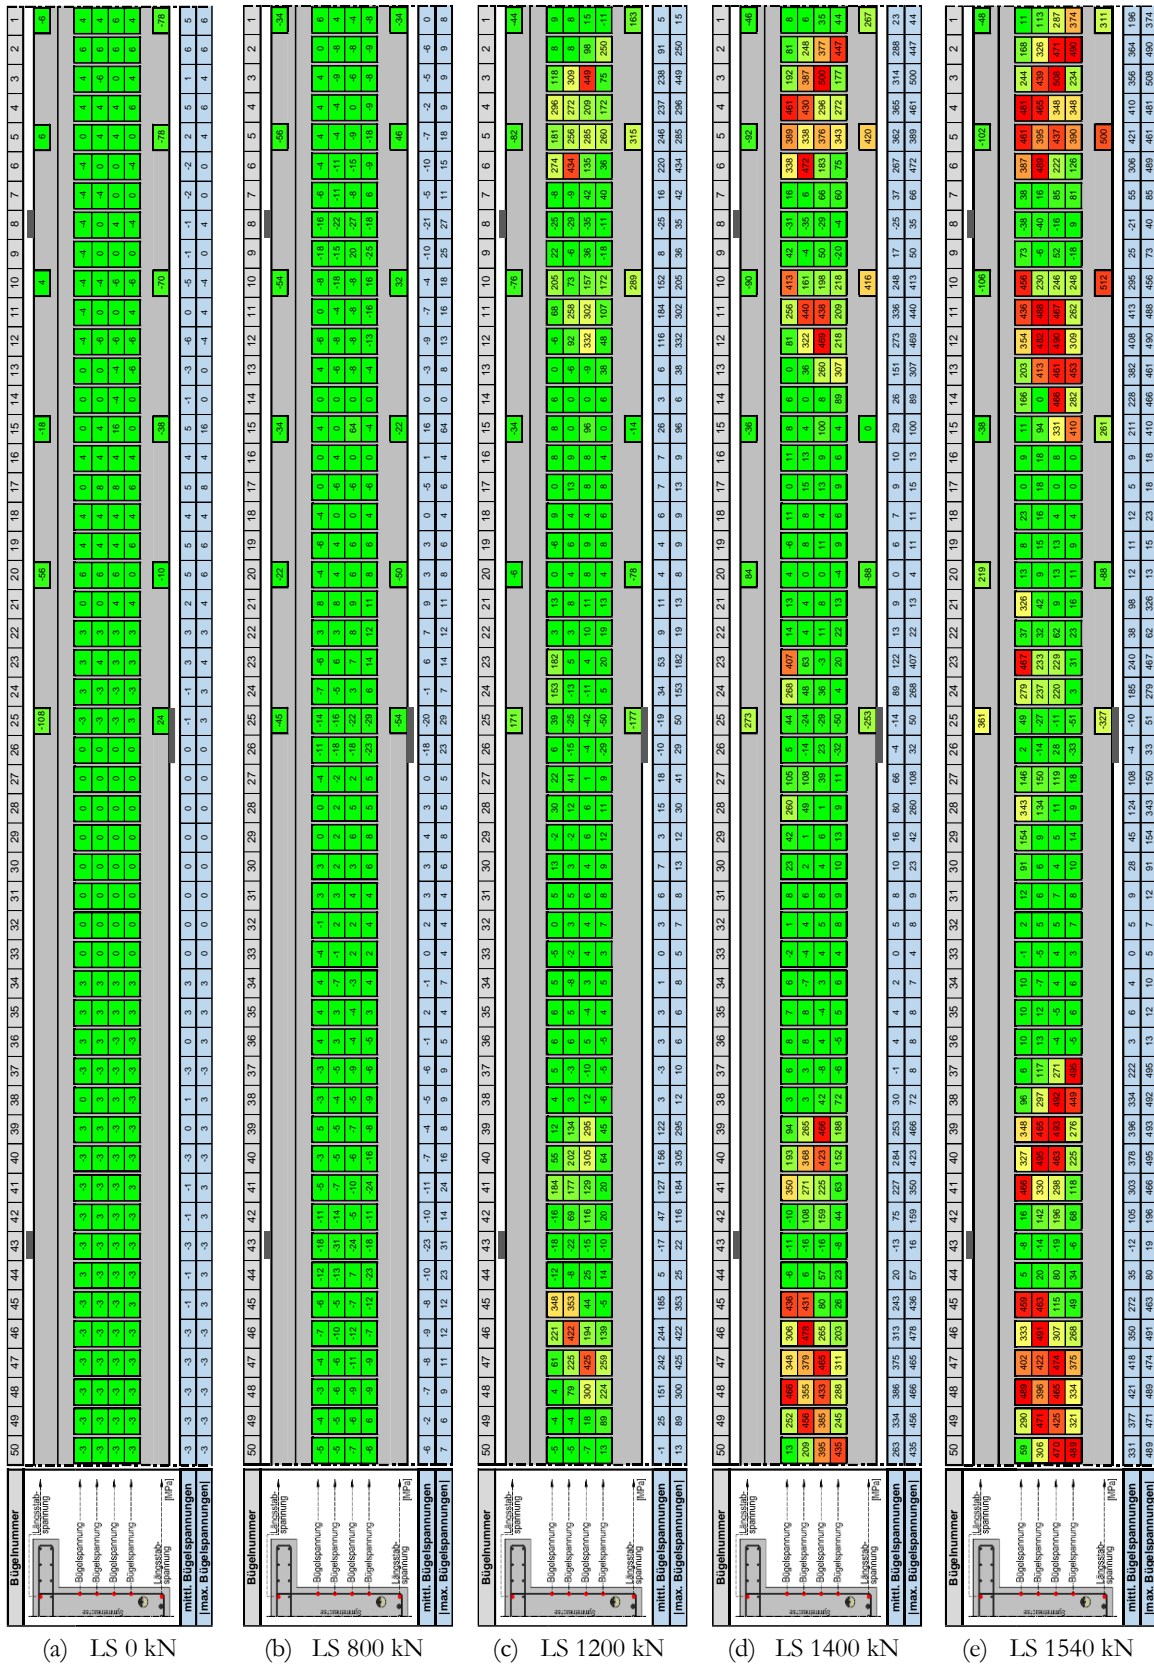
Betonstahlspannungen des Versuchsträgers DLT 1 für ausgewählte Laststufen, Teil 1
